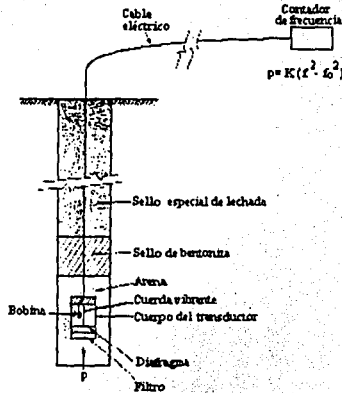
Esquema de un piezómetro a cuerda vibrante instalado en una perforación.
